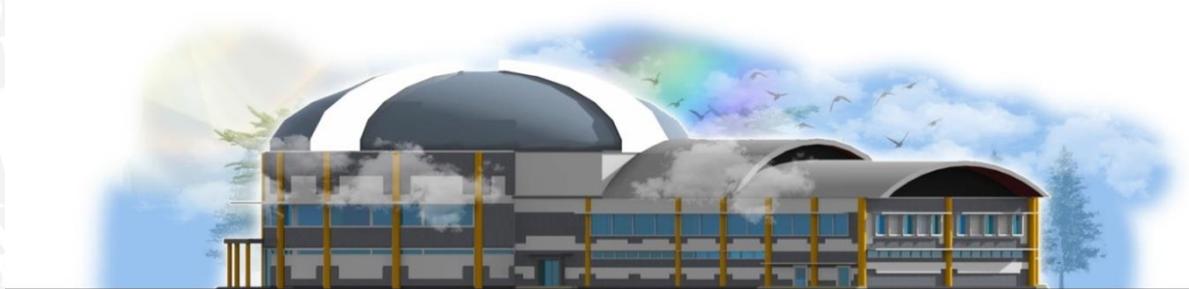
Tampak Belakang Bangunan dengan Rekomendasi Material
